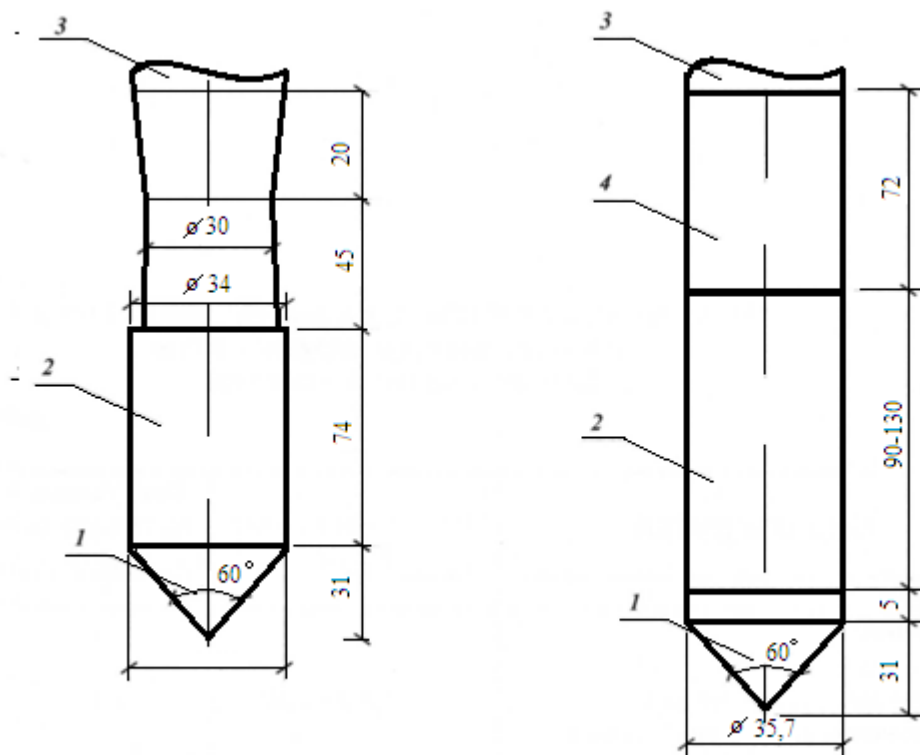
Схемы конструкций зондов для статического зондирования грунтов:
